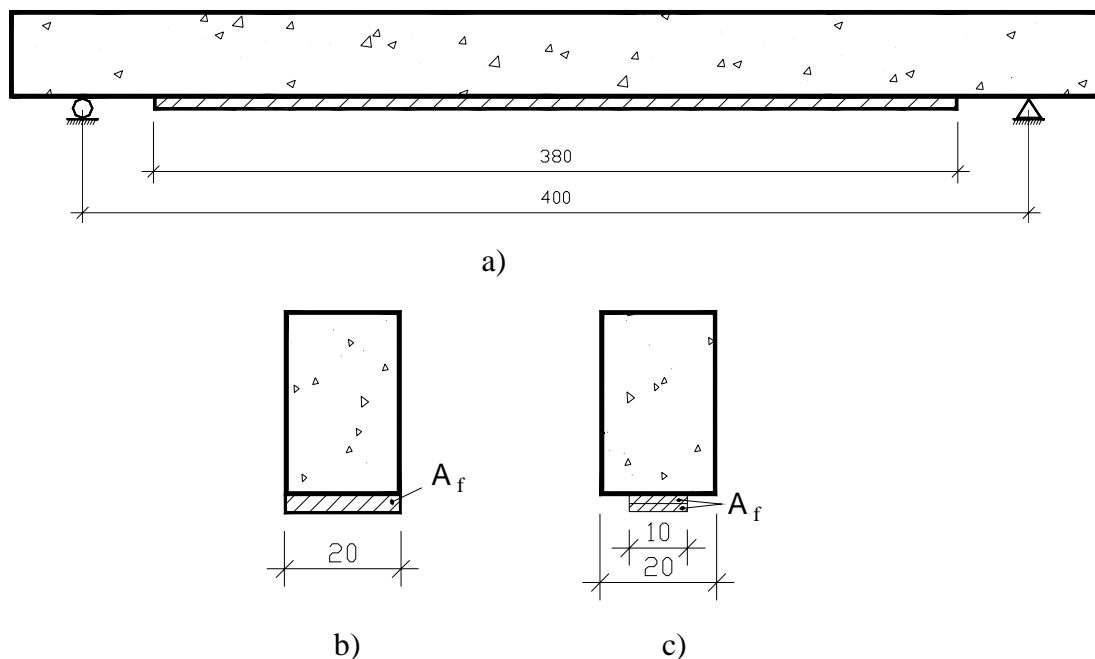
Disposição do tecido de fibra de carbono; a) disposição ao longo do comprimento para todas as vigas; b) vigas AI, BI-1, BI-2; c) vigas AII, BII-1, BII-2. (cotas em cm)
